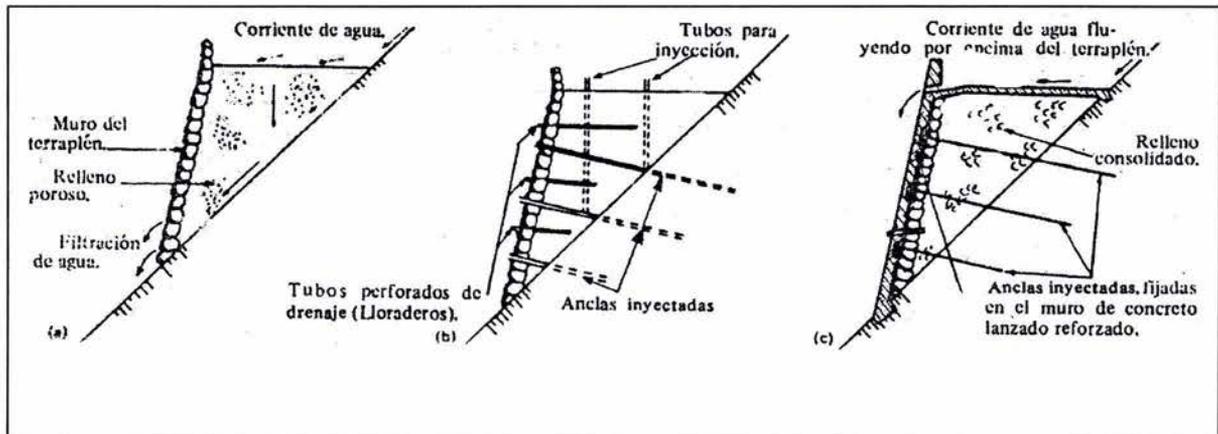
Aplicación del concreto lanzado y mortero inyectado para la reparación de un terraplén en una montaña con peligro de falla.
